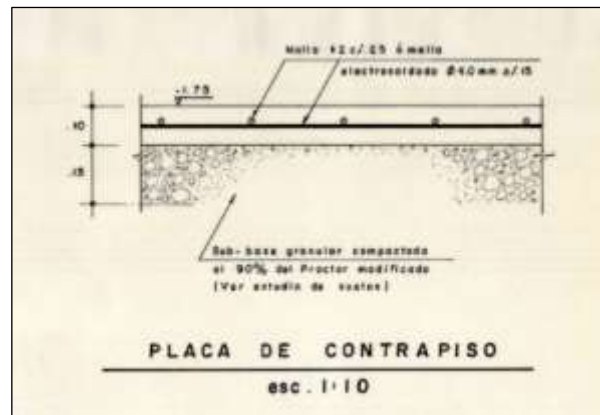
Fuente: autores, (2018). Detalle de placa de contra piso cimentación primer nivel, planos originales alcaldía por Ing. Carlos Navas Camargo.
